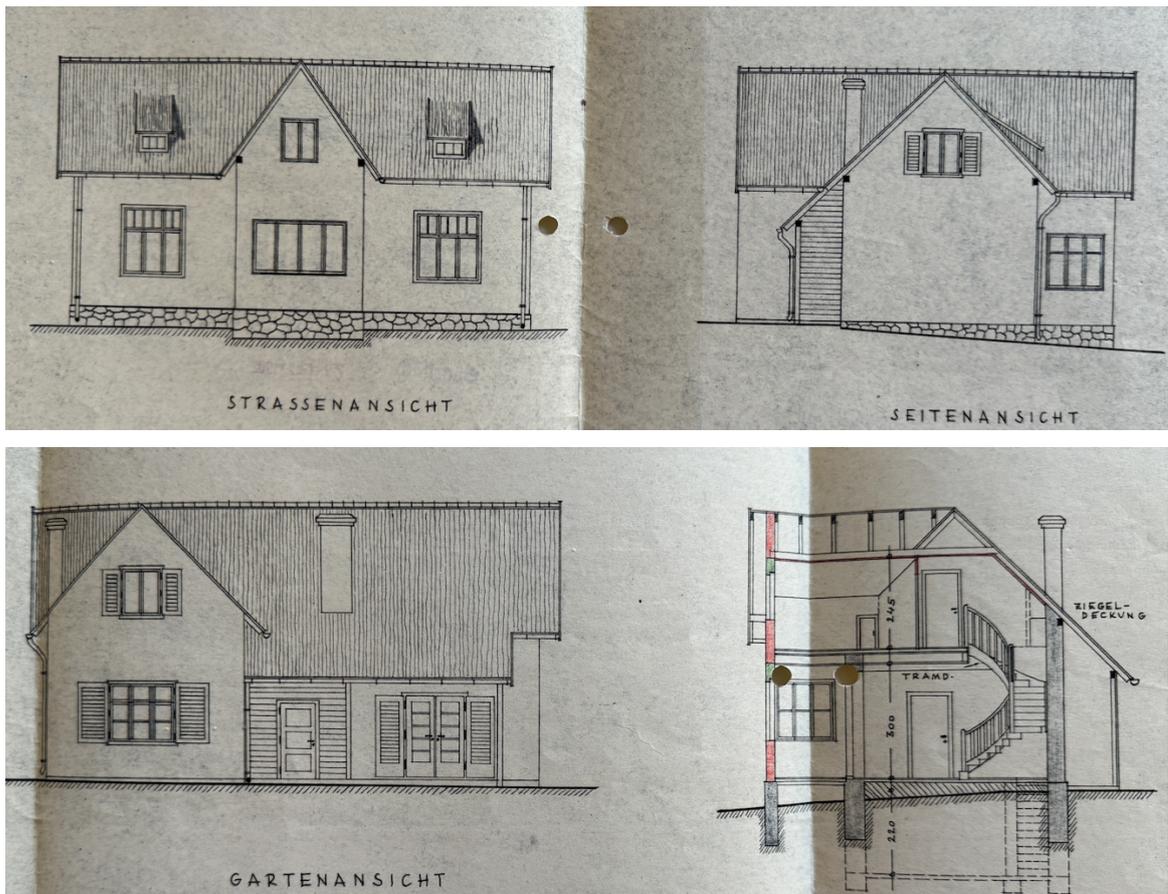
Ansicht / Schnitt (Auswechslungsplan 1961)
